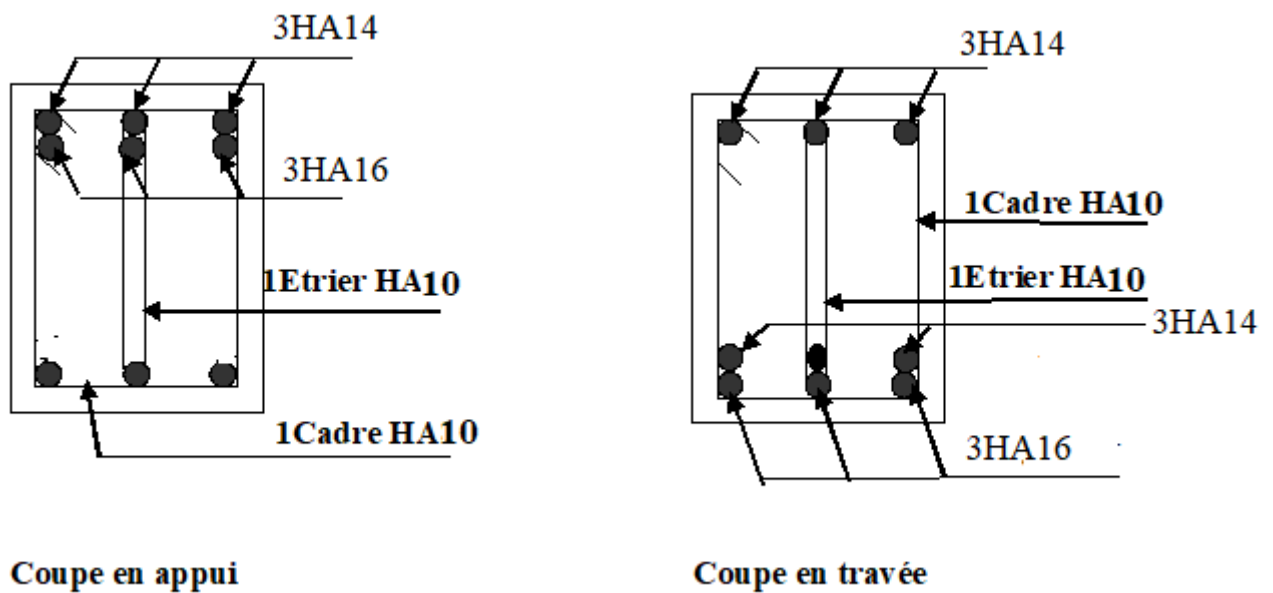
Schéma de ferrailage des poutres principale RDC.
